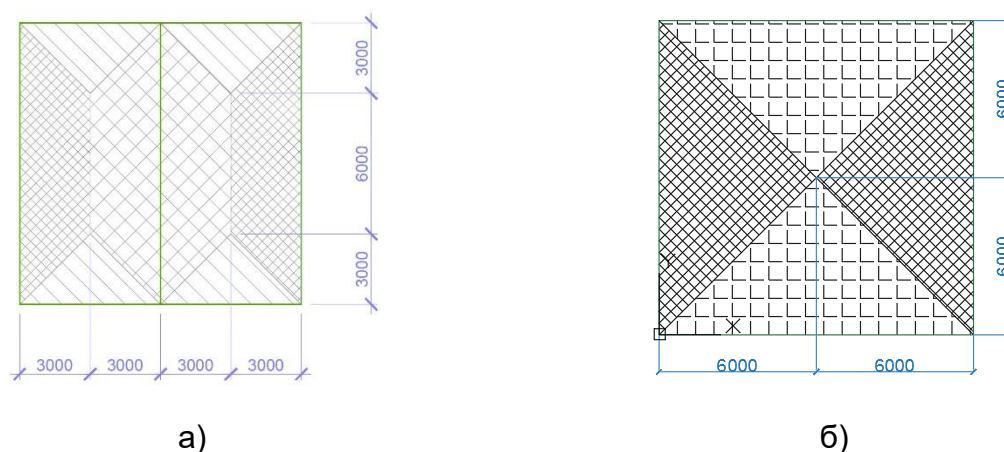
Пример грузовых площадей для монолитных плит перекрытий и покрытия (а) и для многоскатного покрытия (б)
